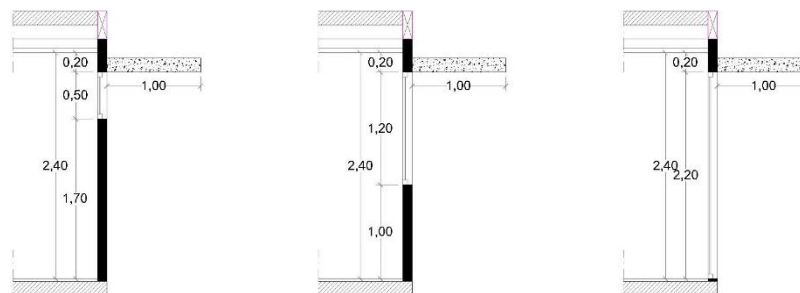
Cortes de las ventanas de 0.50 m, 1.20 m y 2.20 m en Fachada Norte. Elaboración Propia
